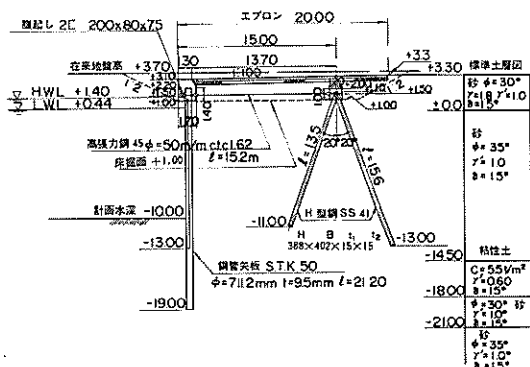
仙台港中野ふ頭6号(-10m)標準断面図
